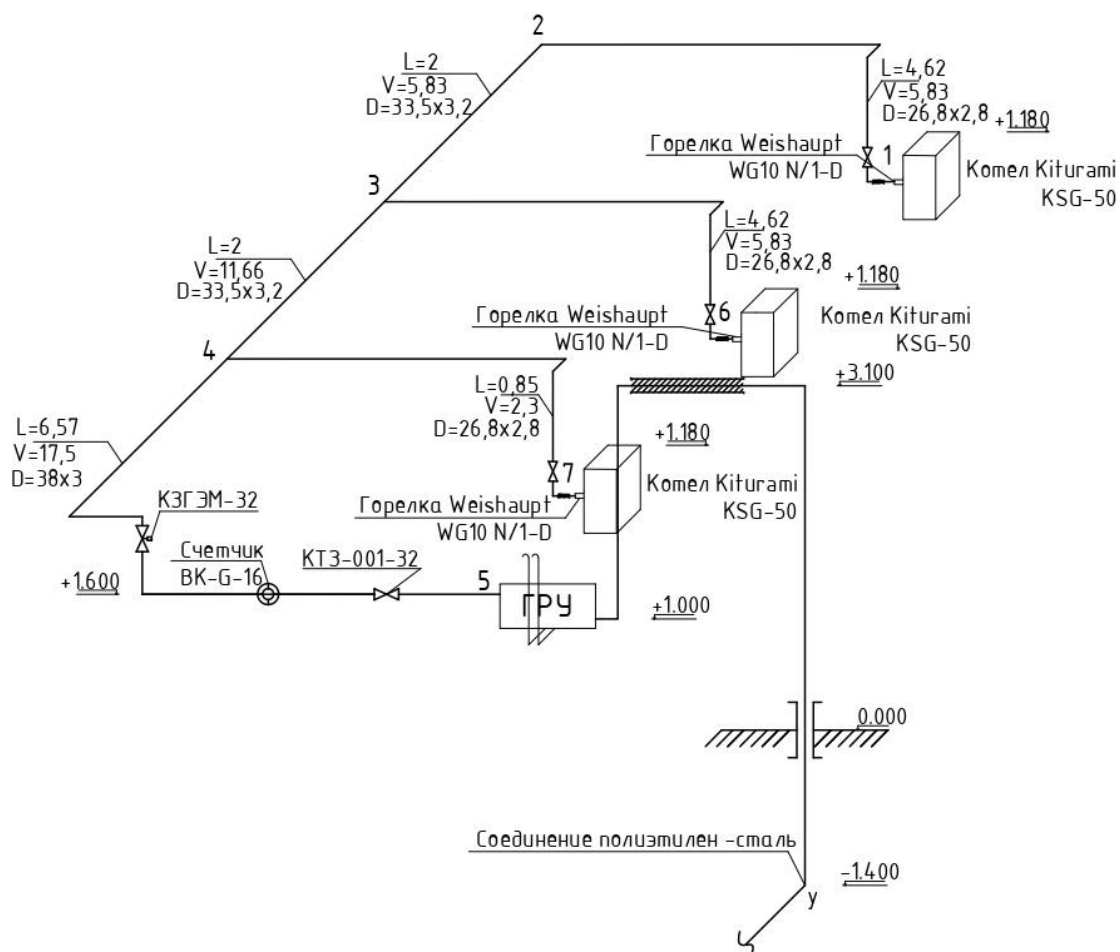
Расчетная схема внутреннего газопровода котельной
